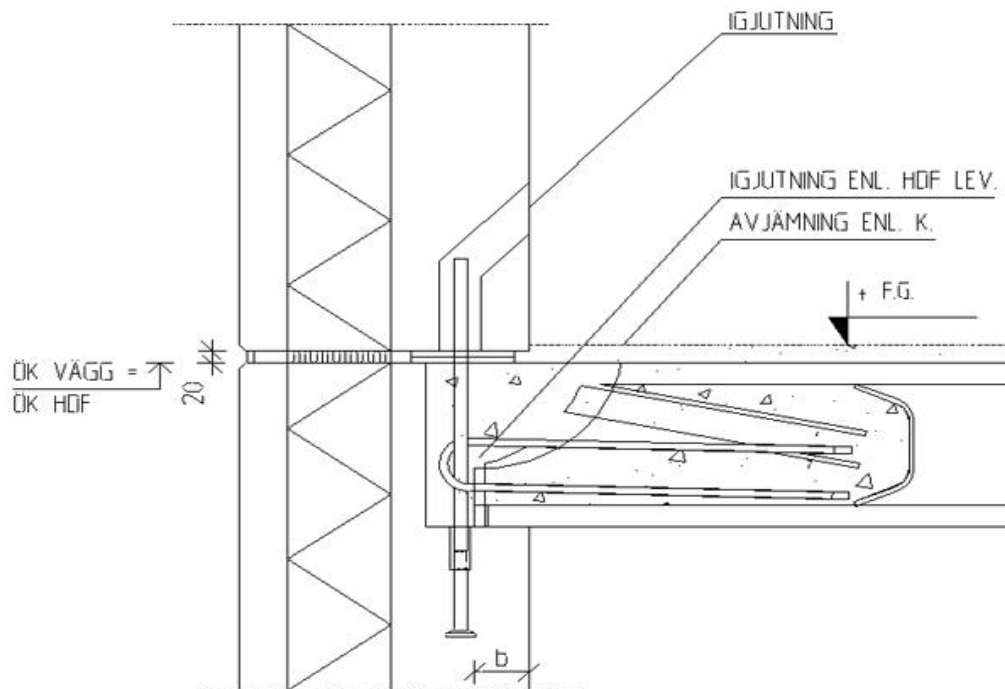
Placering av anslutande armering i fog mellan två HD/F element.
